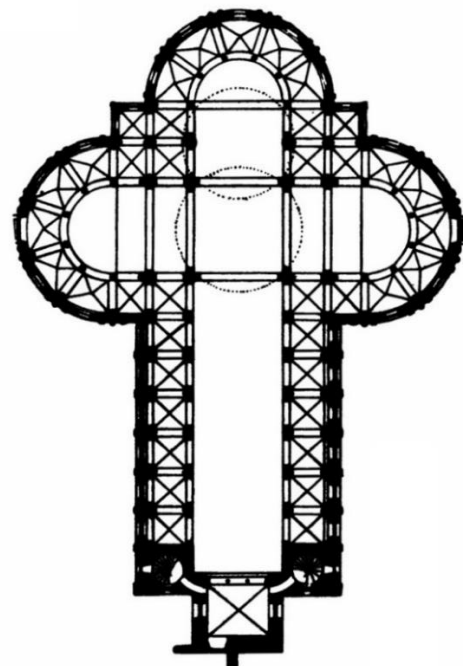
Grundriss St. Maria im Kapitol
